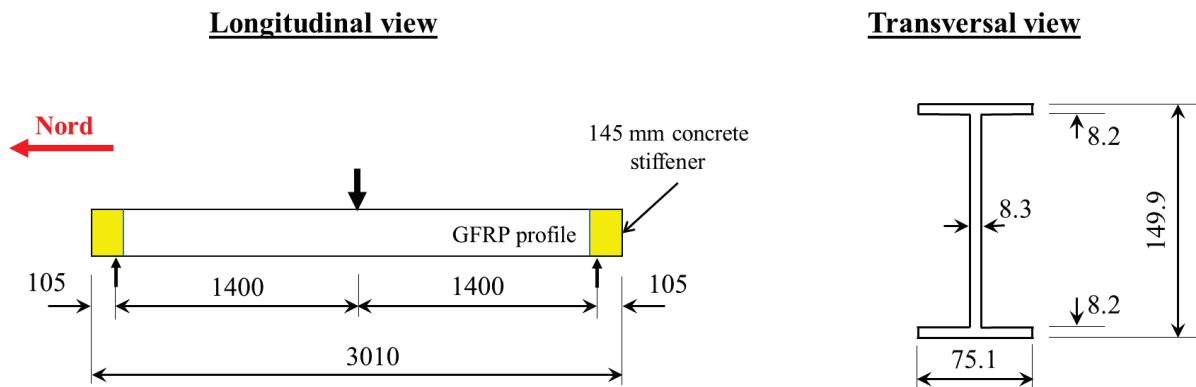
Vues longitudinale et transversale du profilé (dimensions en mm)
